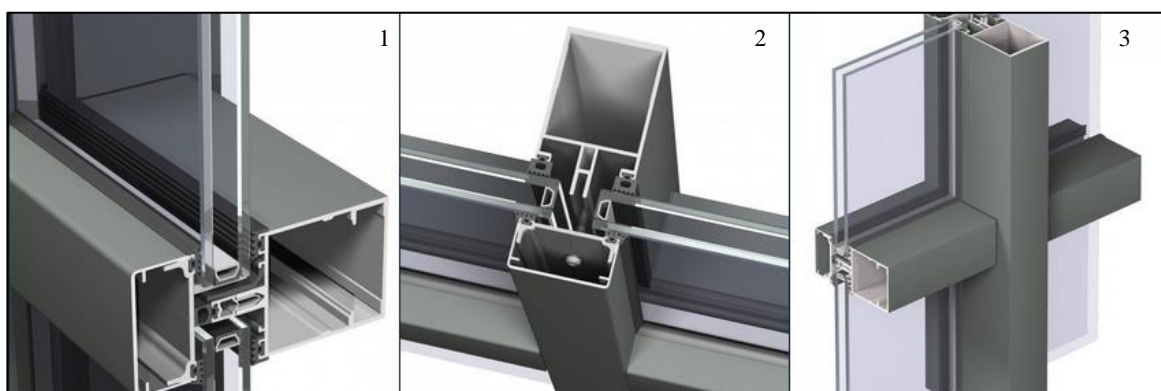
Componentes do sistema CW60 – 1) travessa, 2) montante, 3) montagem.
